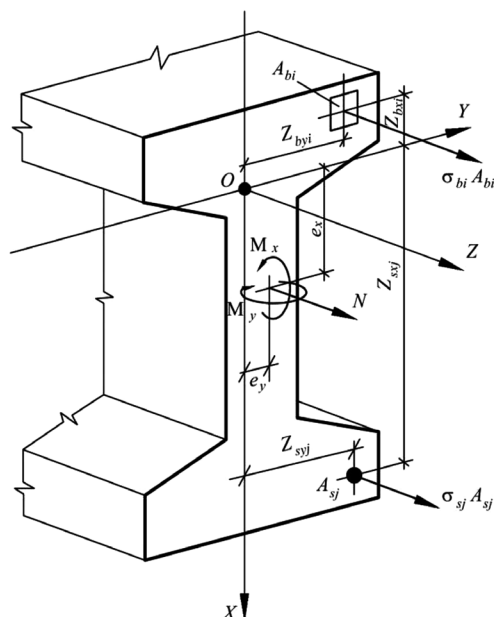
Расчетная схема нормального сечения железобетонного элемента
